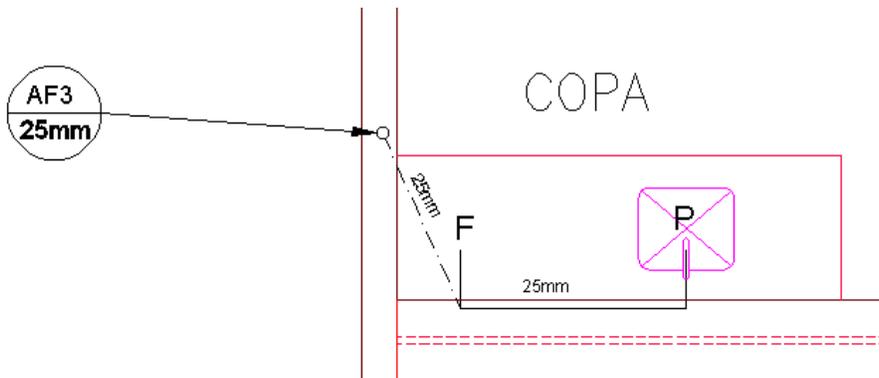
Exemplo de Planta Baixa de Detalhe escala 1:20 ou 1:25.
